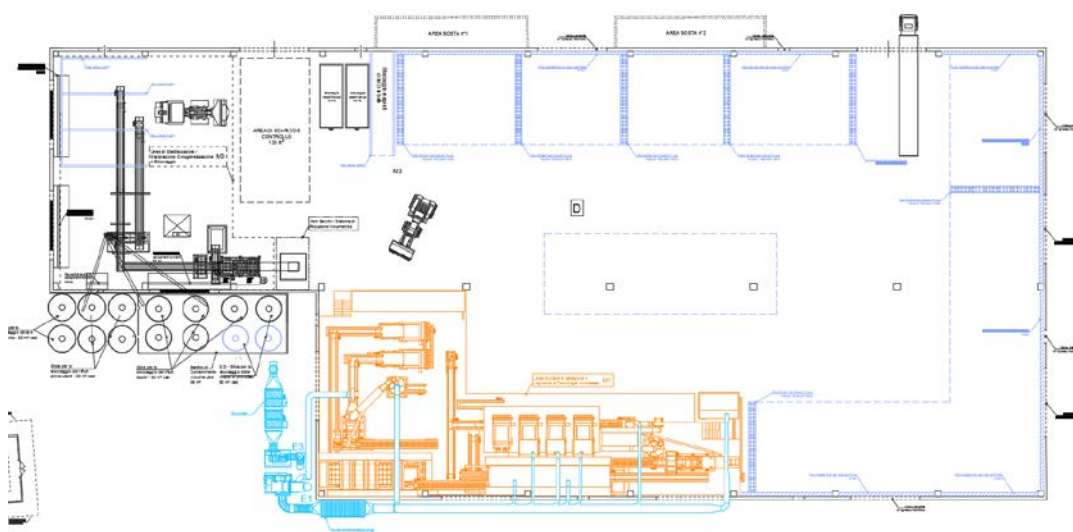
Stralcio Allegato S - Plan. Generale dell'impianto - Proposta di modifica - In arancio nuova posizione Linea M1
